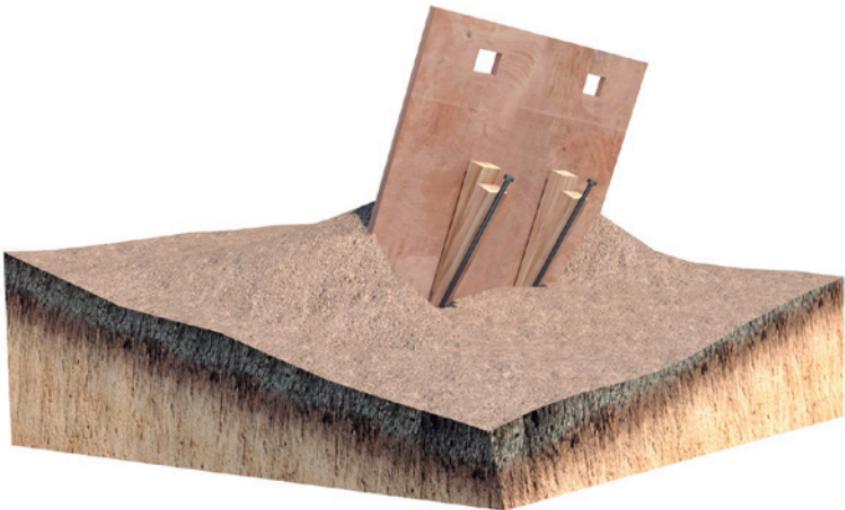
Sistema de apuntalamiento de placas - apoyo simple.
